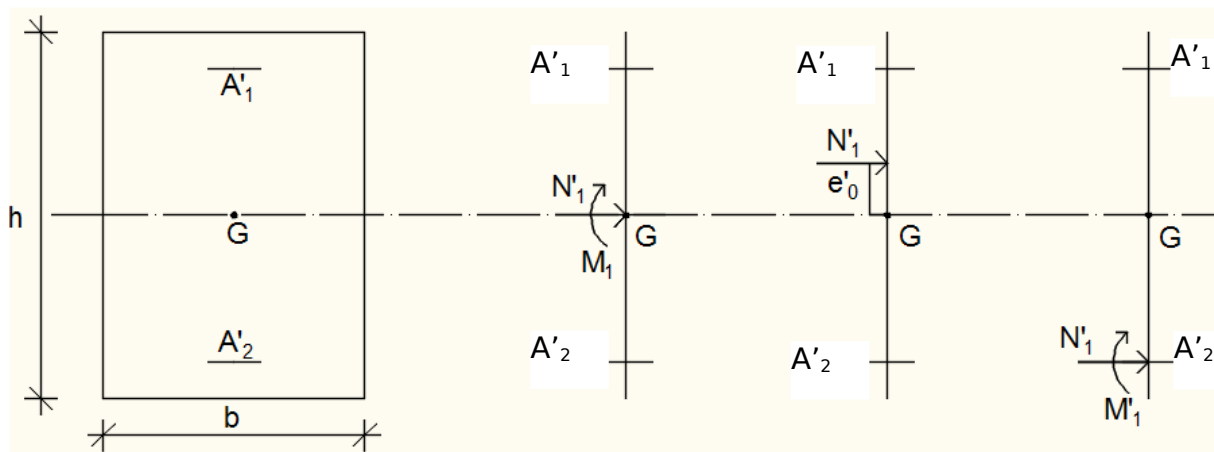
Position de N'_1 , M'_1 et M_1 sur la section transversale.
